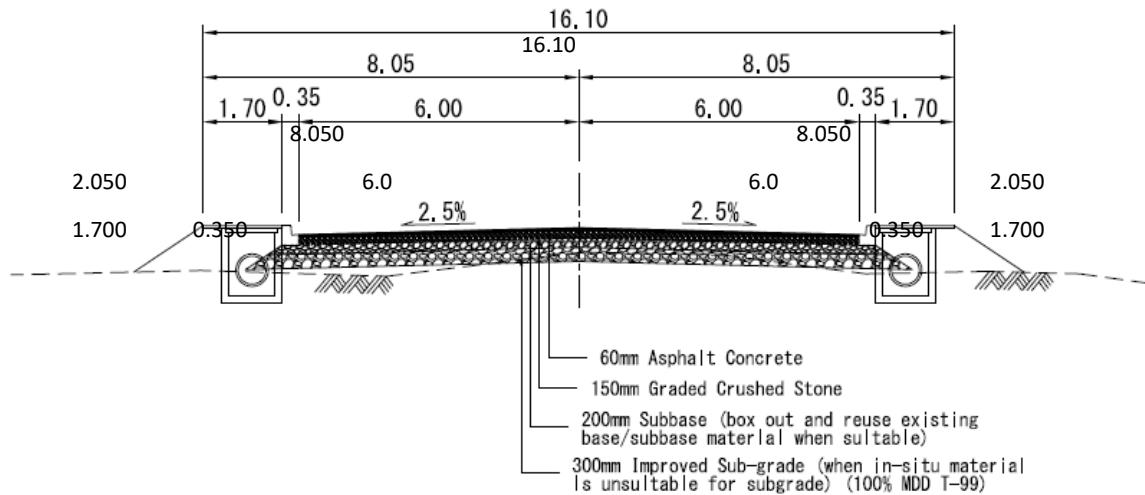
道路標準断面 (計画) Road C2 (橋梁 No.1)
